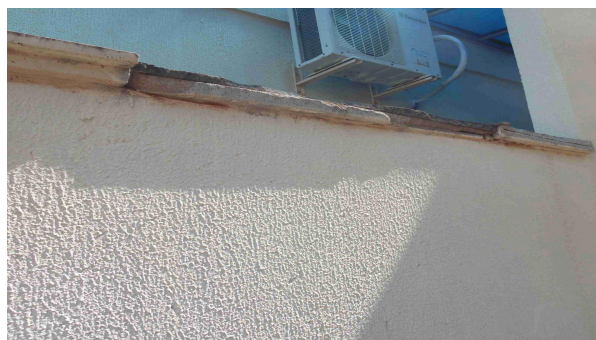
Detalhe das pingadeiras instaladas no muro interno, que se apresentam completamente soltas ou danificadas, sendo necessária a substituição de todas
